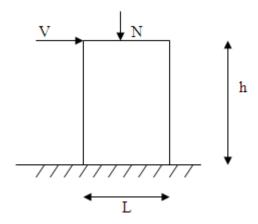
Section rectangulaire, soumise à la flexion composée.
